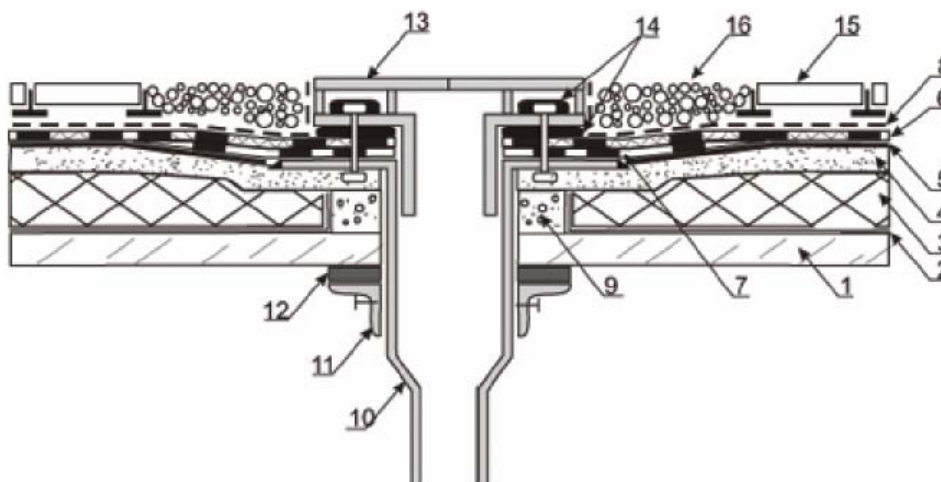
Примыкание кровли к водоприемной воронке для традиционной кровельной системы. (Эксплуатируемое покрытие).
